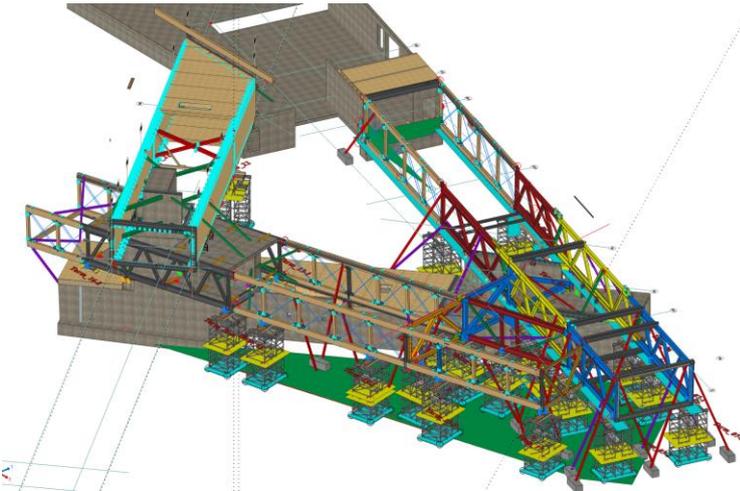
Planung Lastgerüste CAD, Quelle: Werkstattplanung ZÜBLIN Timber
